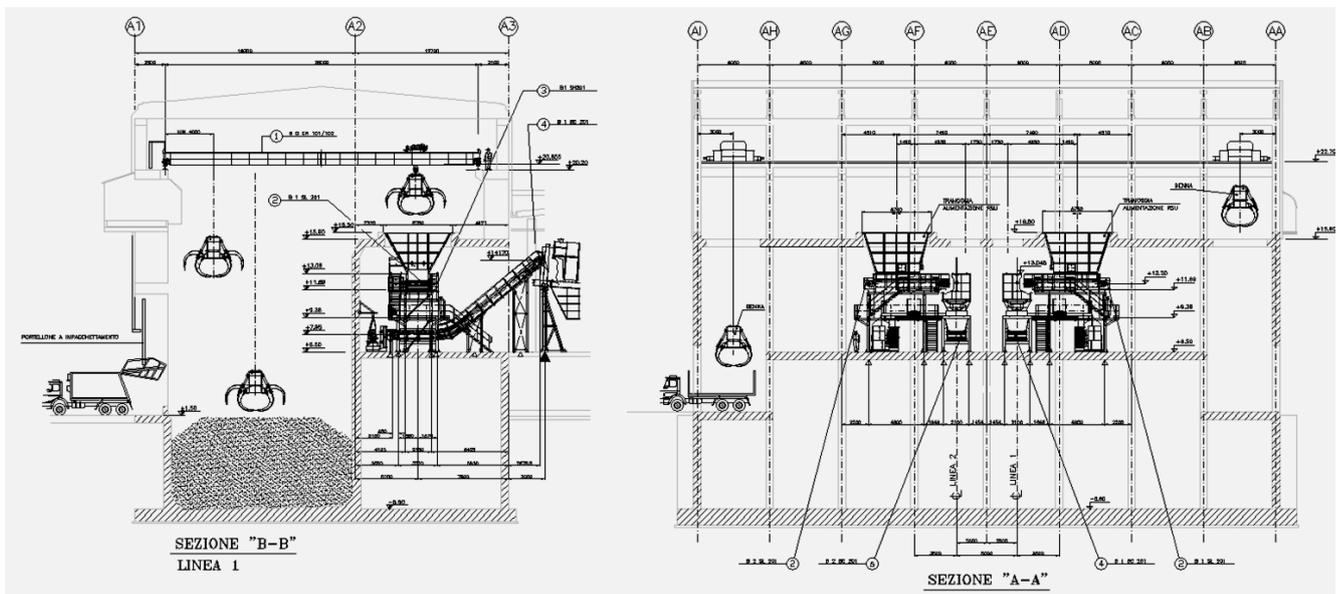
Sezione locale conferimento e fossa - Sezioni
